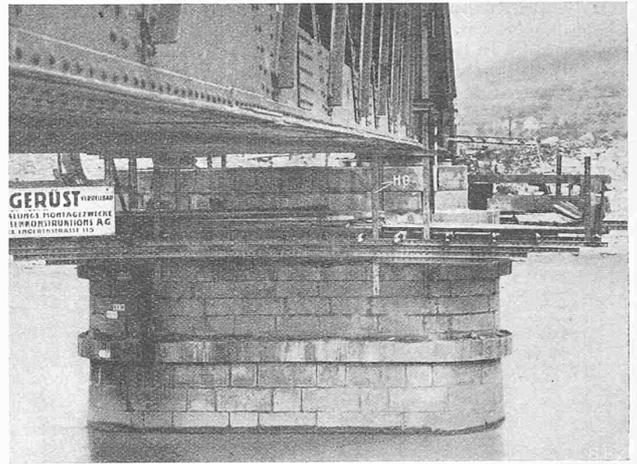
Hängegerüst für die Aufmauerung des Mittelpfeilers.
